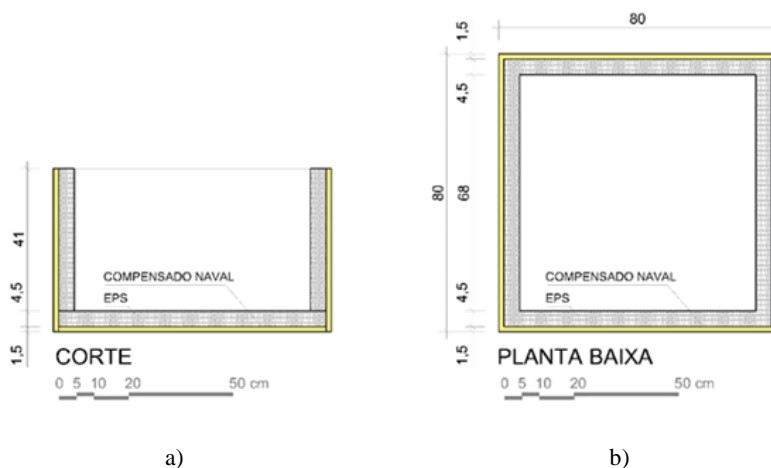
Corte (a) e Planta Baixa (b) da Célula Teste.
